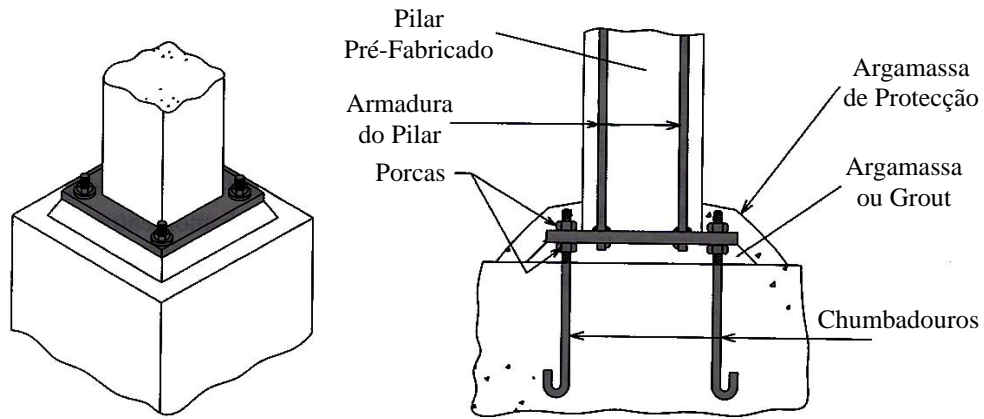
Ligação pilar - fundação com chumbadouros, adaptado de [7]
